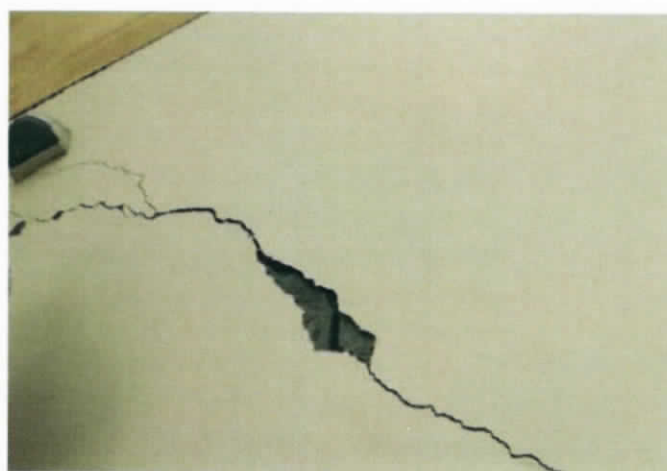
Grietas en eje 2 en paños de albañilería en pisos 1 y piso 2
